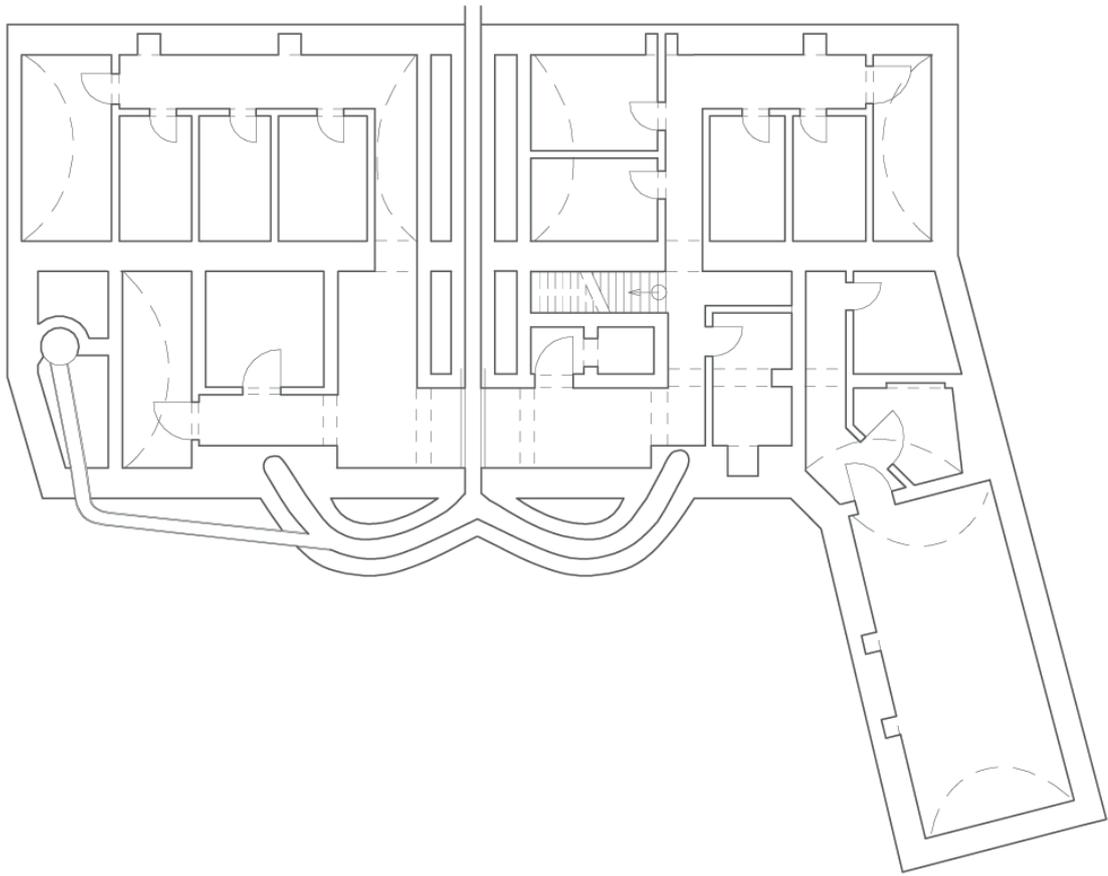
Scan der Originalgrundrisse Währingerstraße 41
